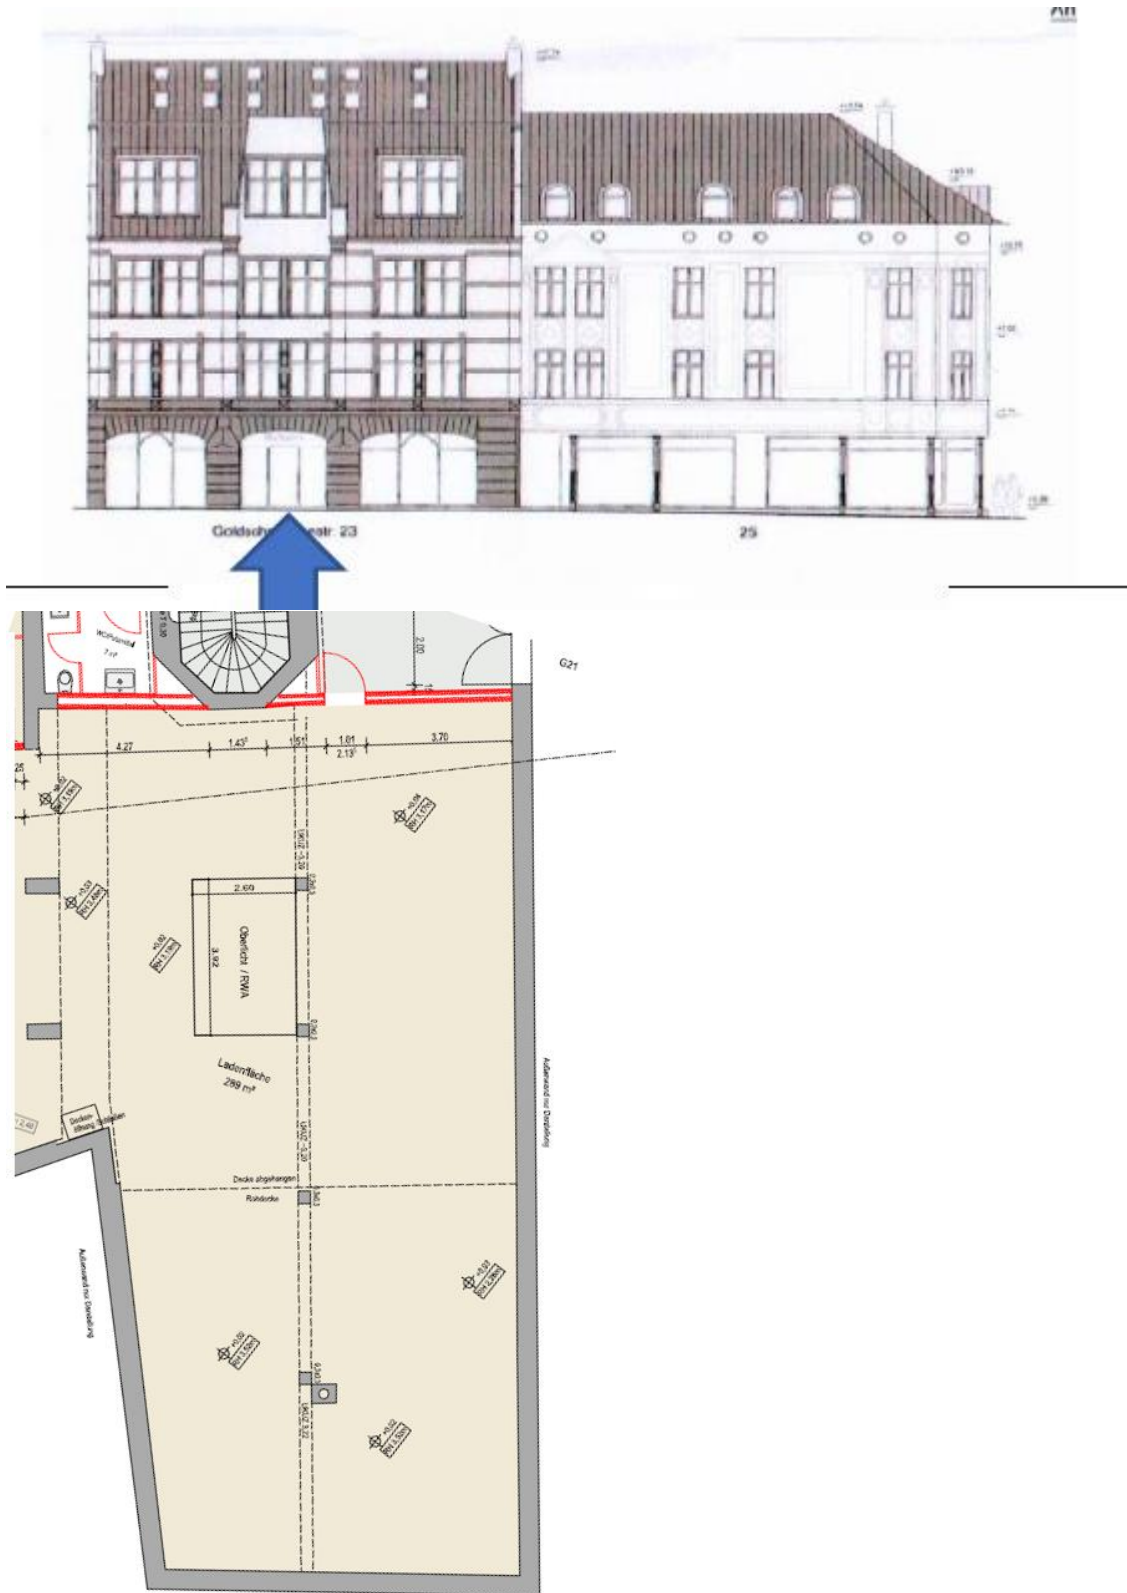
Außenansicht mit Grundriss (Eventhalle)
